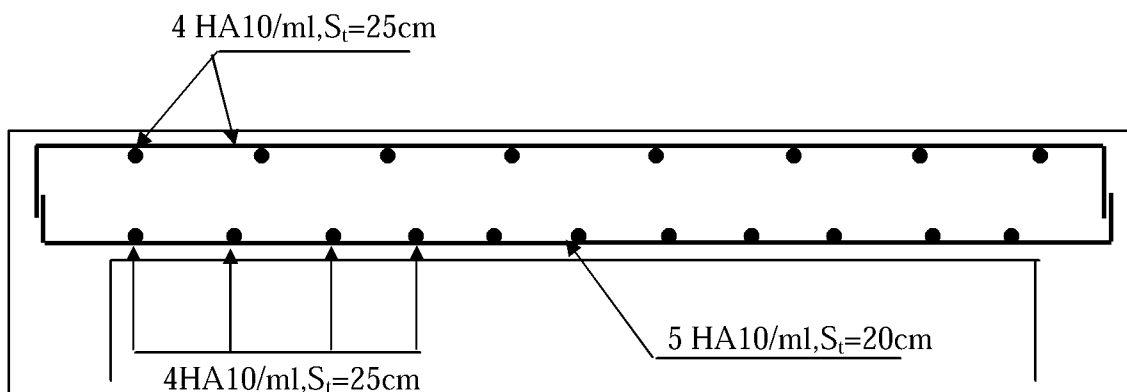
Plan de ferrailage de la salle machine suivant x-x.
